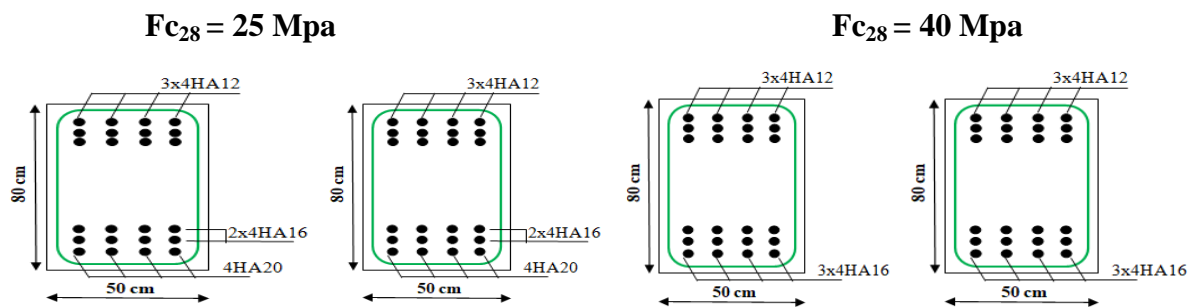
Schéma de ferrailage de la poutre libage .
